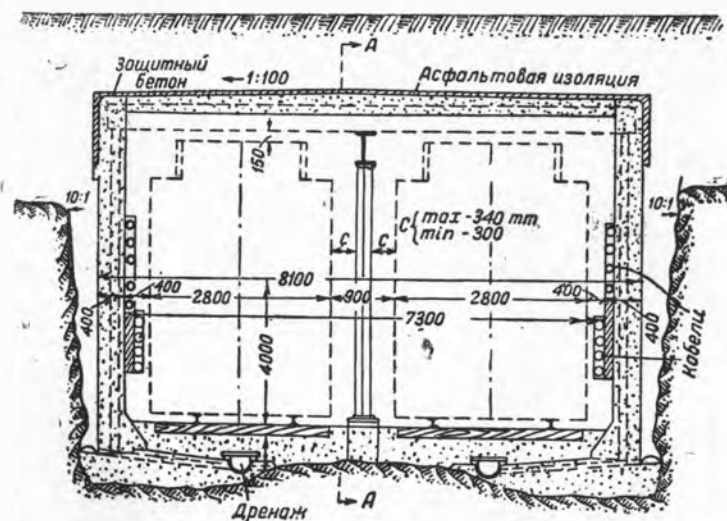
Конструкция двухпутного тоннеля с плоским перекрытием.
